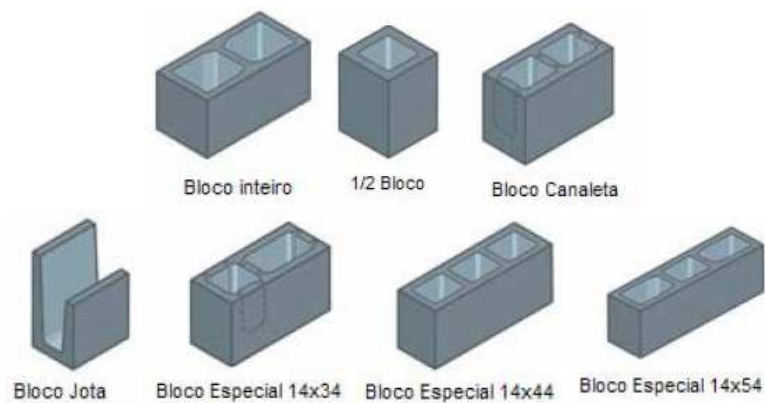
Blocos de concreto para alvenaria estrutural.
